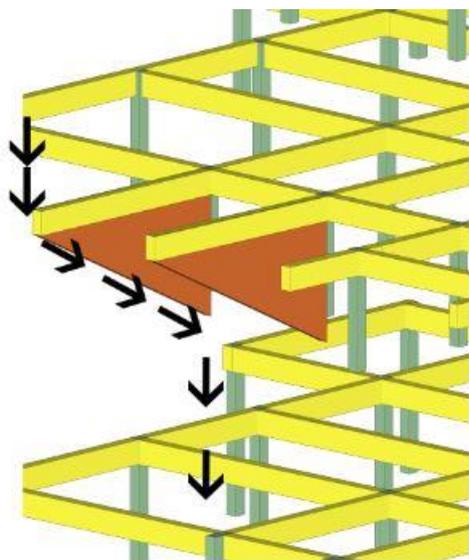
Sistem transfer beban struktur kolom dan balok beton.
